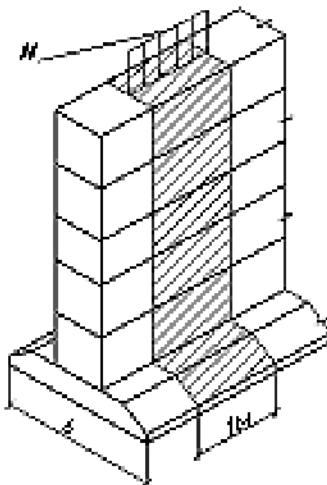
Схема збору навантажень на 1м довжини фундаменту
